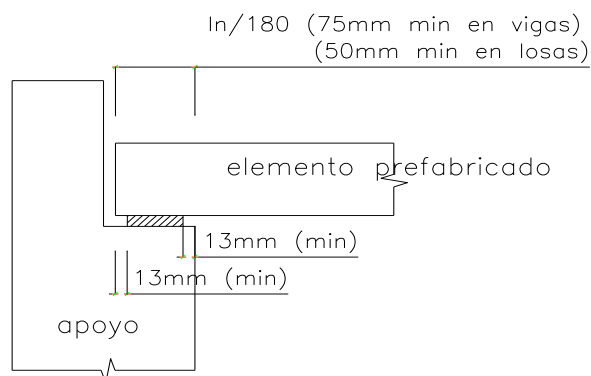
Longitud de apoyo de un elemento prefabricado.
